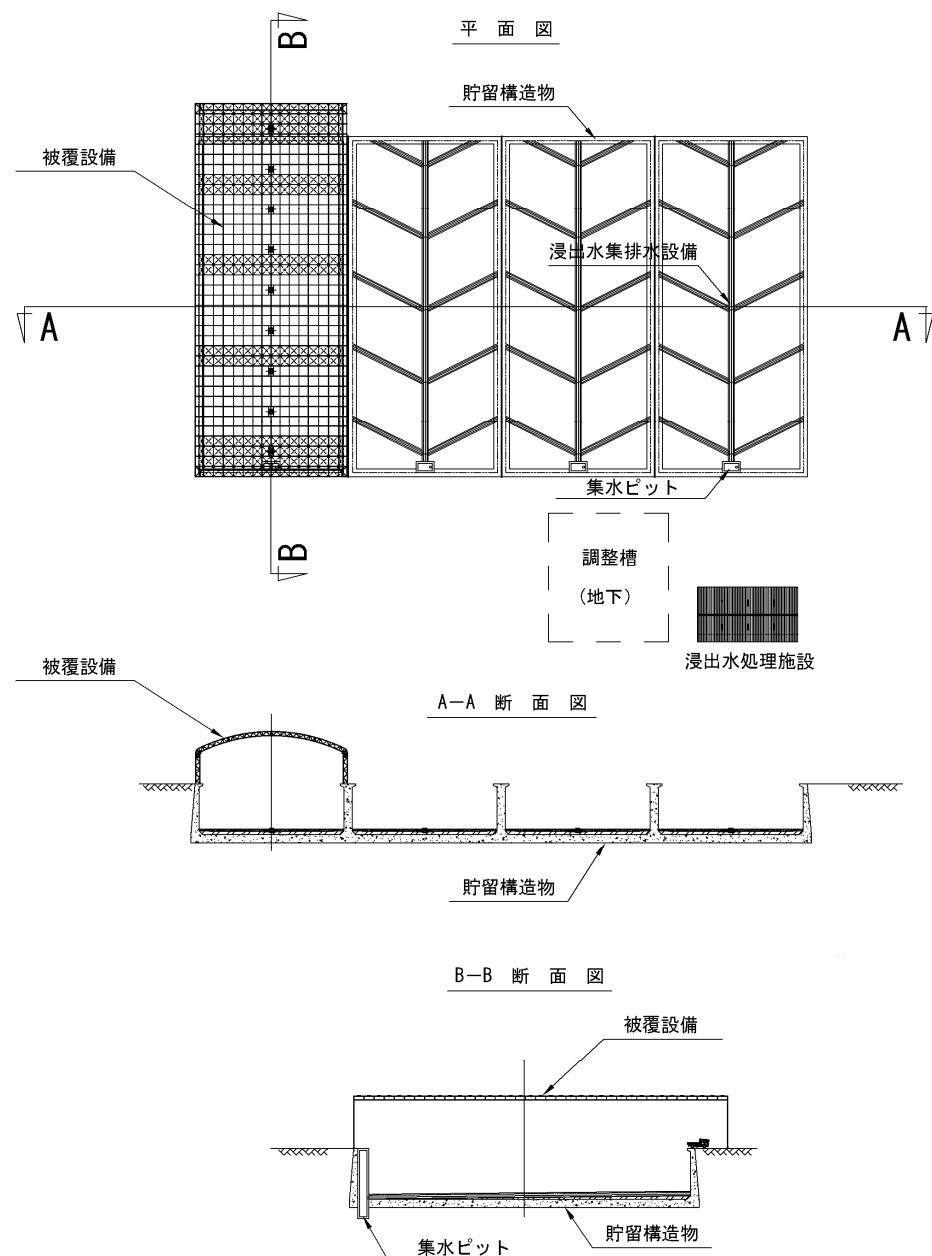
(1) 埋立地の形態及び構造（平面図、断面図）
